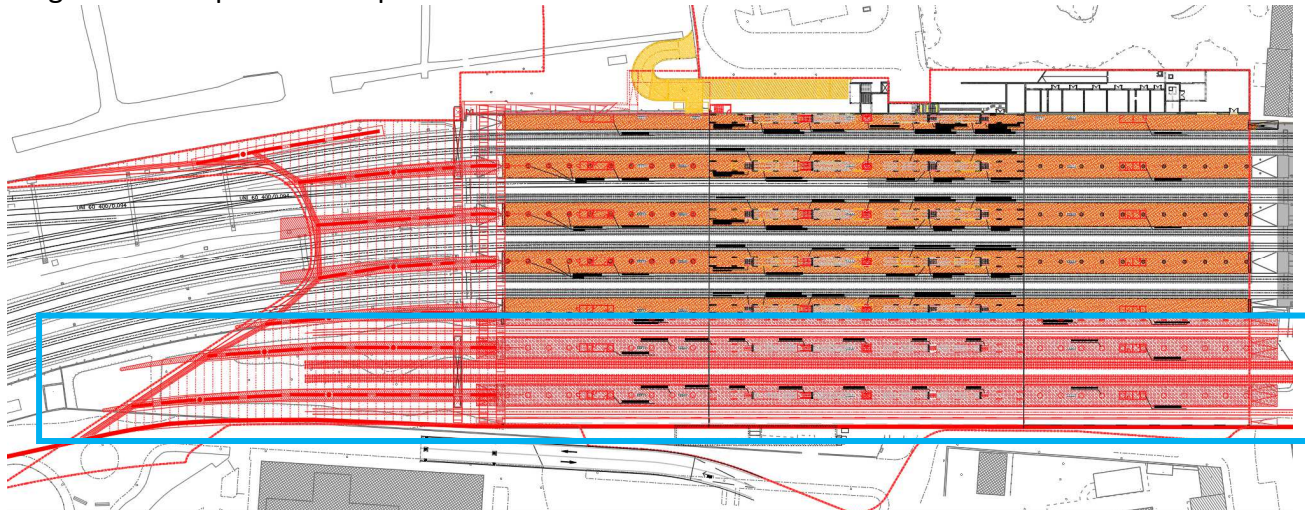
Planimetria generale stazione di Bovisa con indicazione dell'ampliamento.
